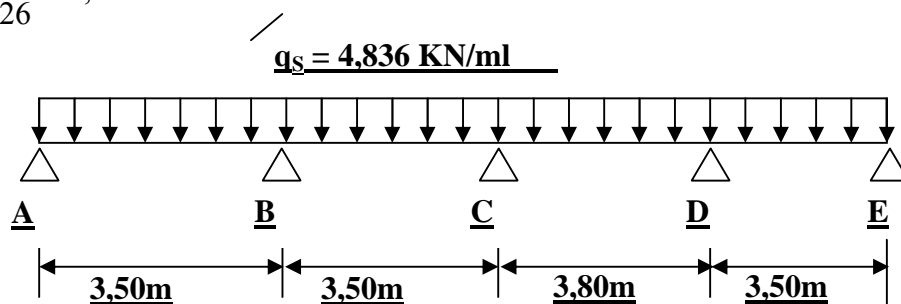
Schéma statique de la poutrelle.
